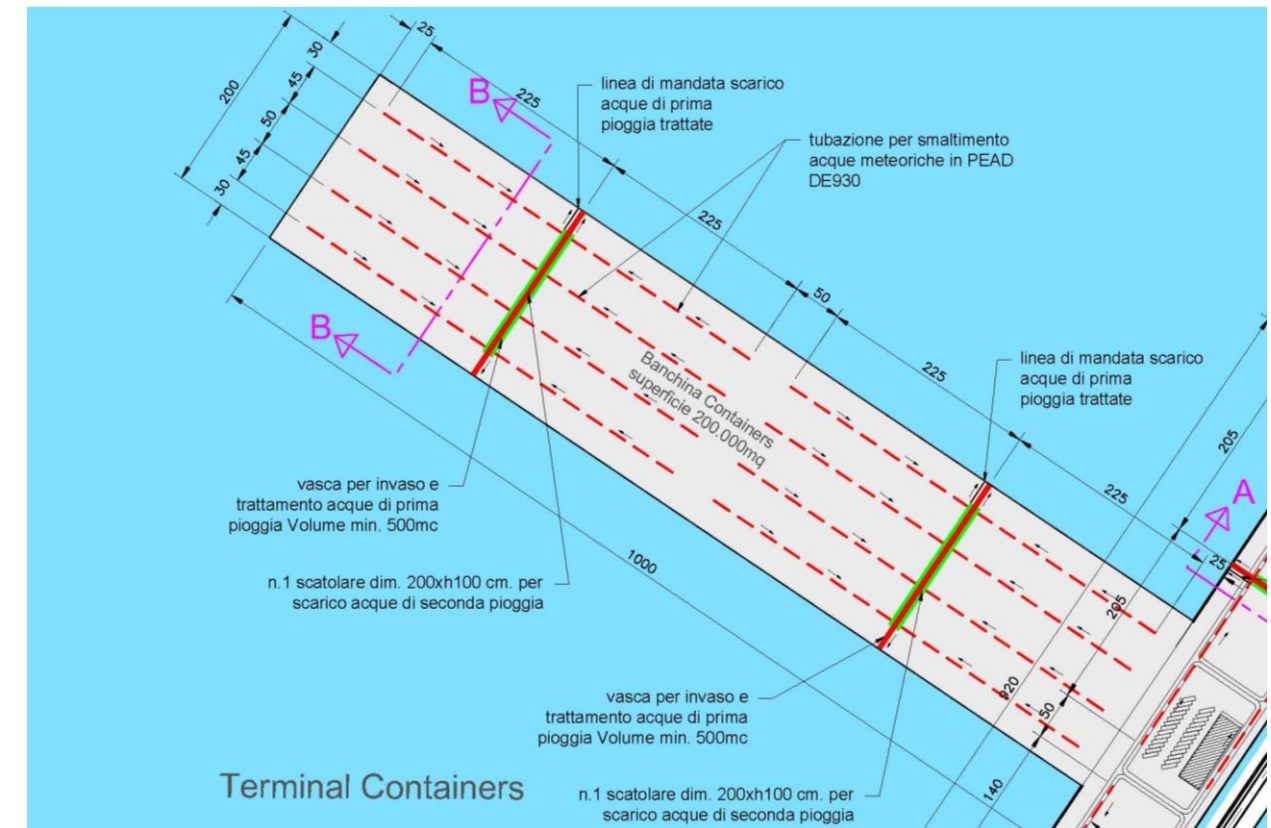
Banchina containers – planimetria rete di smaltimento acque meteoriche
